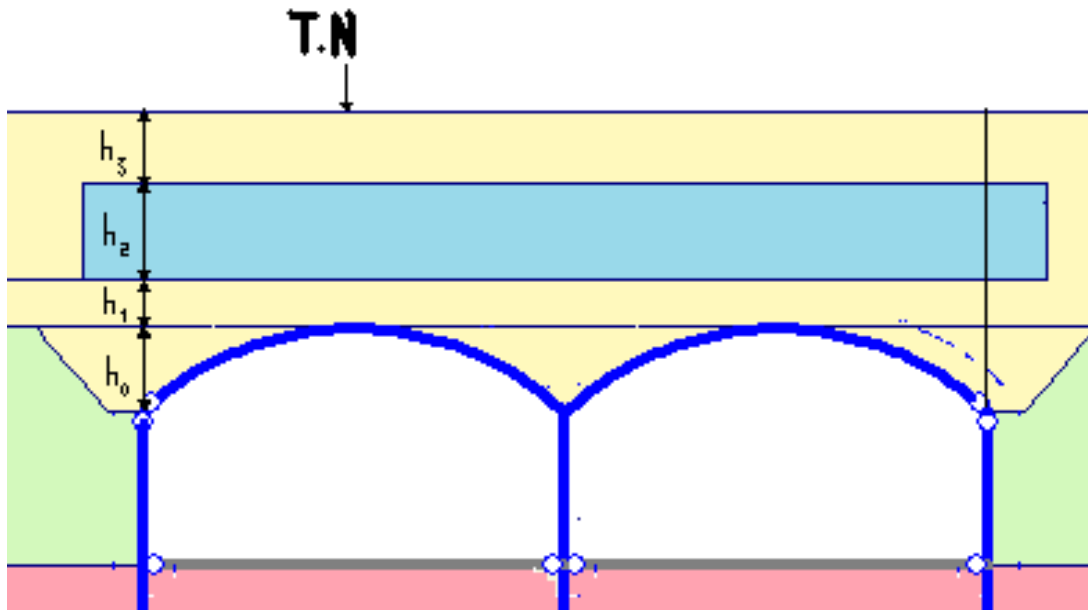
hauteur des couches de remblai sur la voûte
